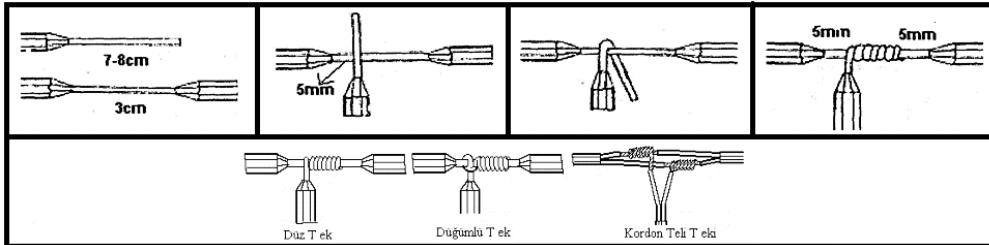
Birinci damarın 90° açı ile çapraz tutulması ve birbirine üzerine sarılması
